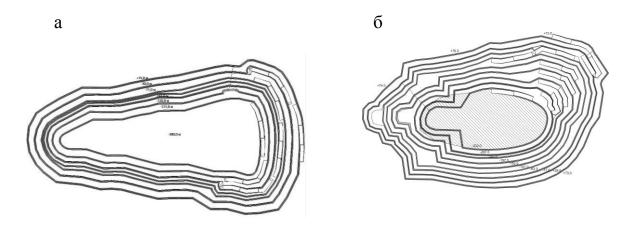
Схема развития карьерного поля при отработке горизонтов крутонаклонными слоями с перемещением фронта горных работ диагоналями (а) или с формированием поперечных блоков (б)
